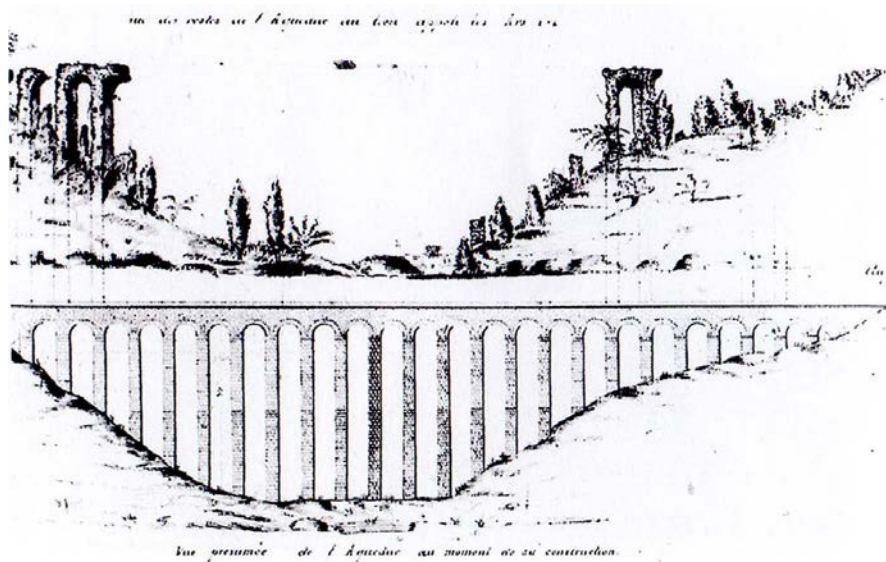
Extrait d'un plan de 1832, auteur inconnu. © M. Rouyer-Guillet
